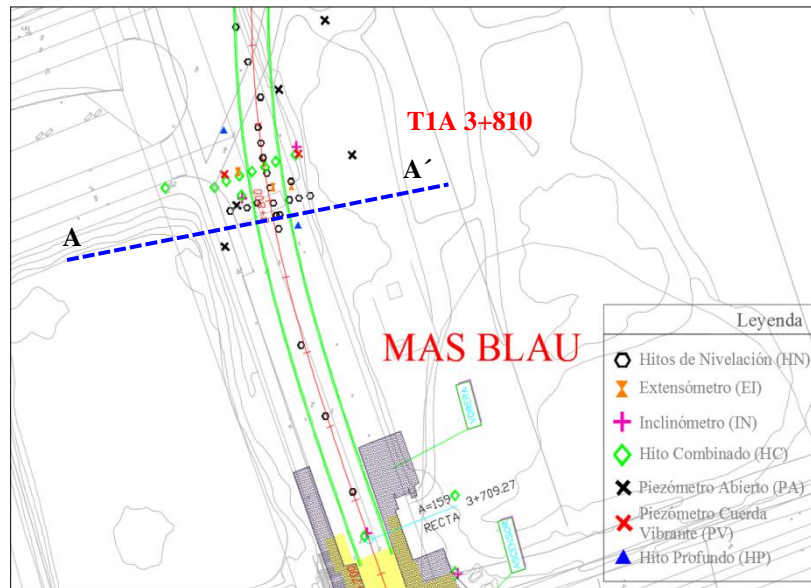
18. Situación en planta del túnel y la sección de control T1D PK 3+810
